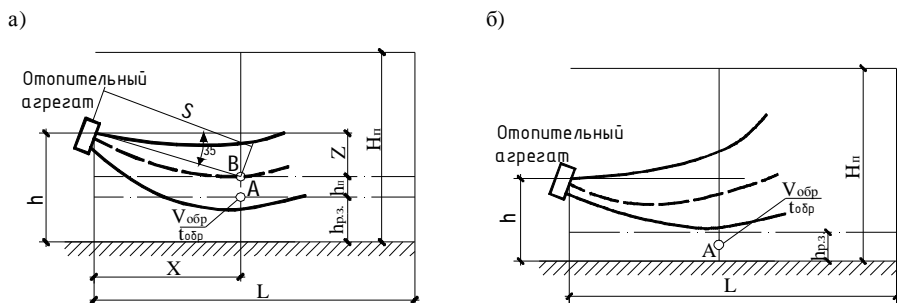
Схемы подачи нагретого воздуха отопительным агрегатом: а - наклонная подача; б - сосредоточенная подача; А - расчетная точка в рабочей зоне; В - вершина воздушной струи
